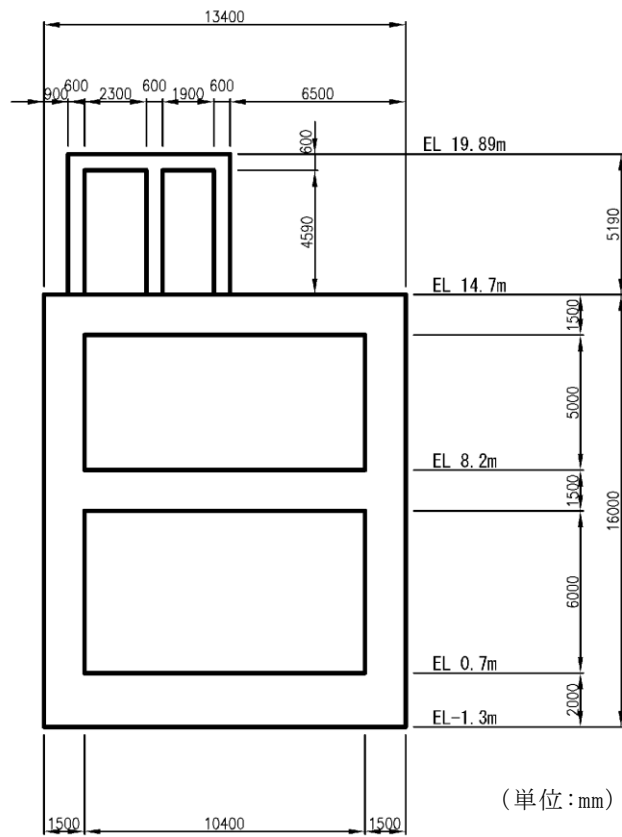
(5) 低圧原子炉代替注水ポンプ格納槽 断面図 (E-E断面)
